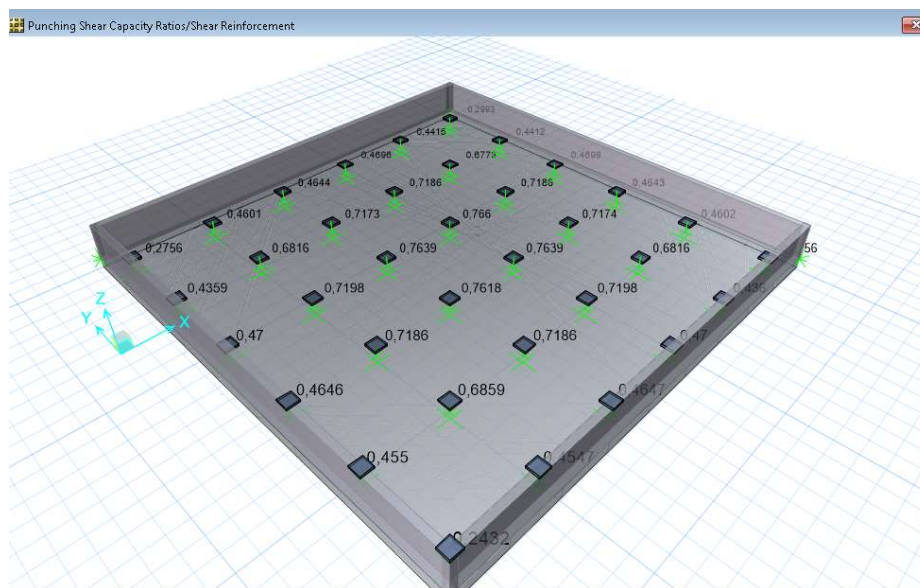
Modelado 3D de la losa de cimentación, revisión de punzonamiento.
